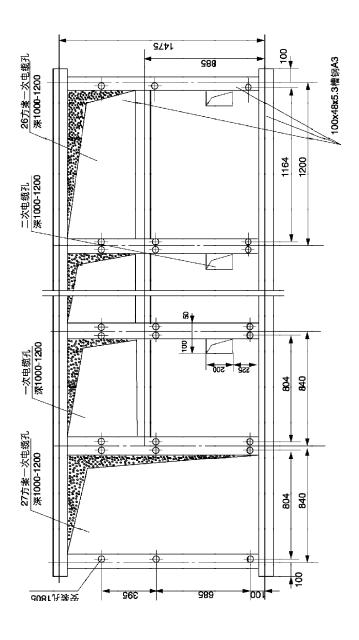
安装基础参考图 (槽钢与地面处于同一平面) Figure 11 the reference of foundation installation (box iron and ground are in one plane)
